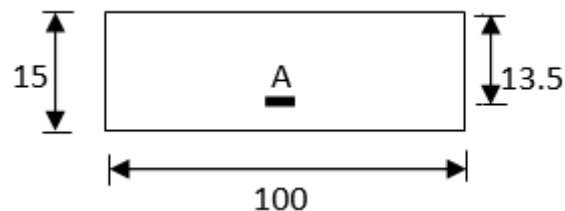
Section du calcul de la dalle pleine d'ascenseur
